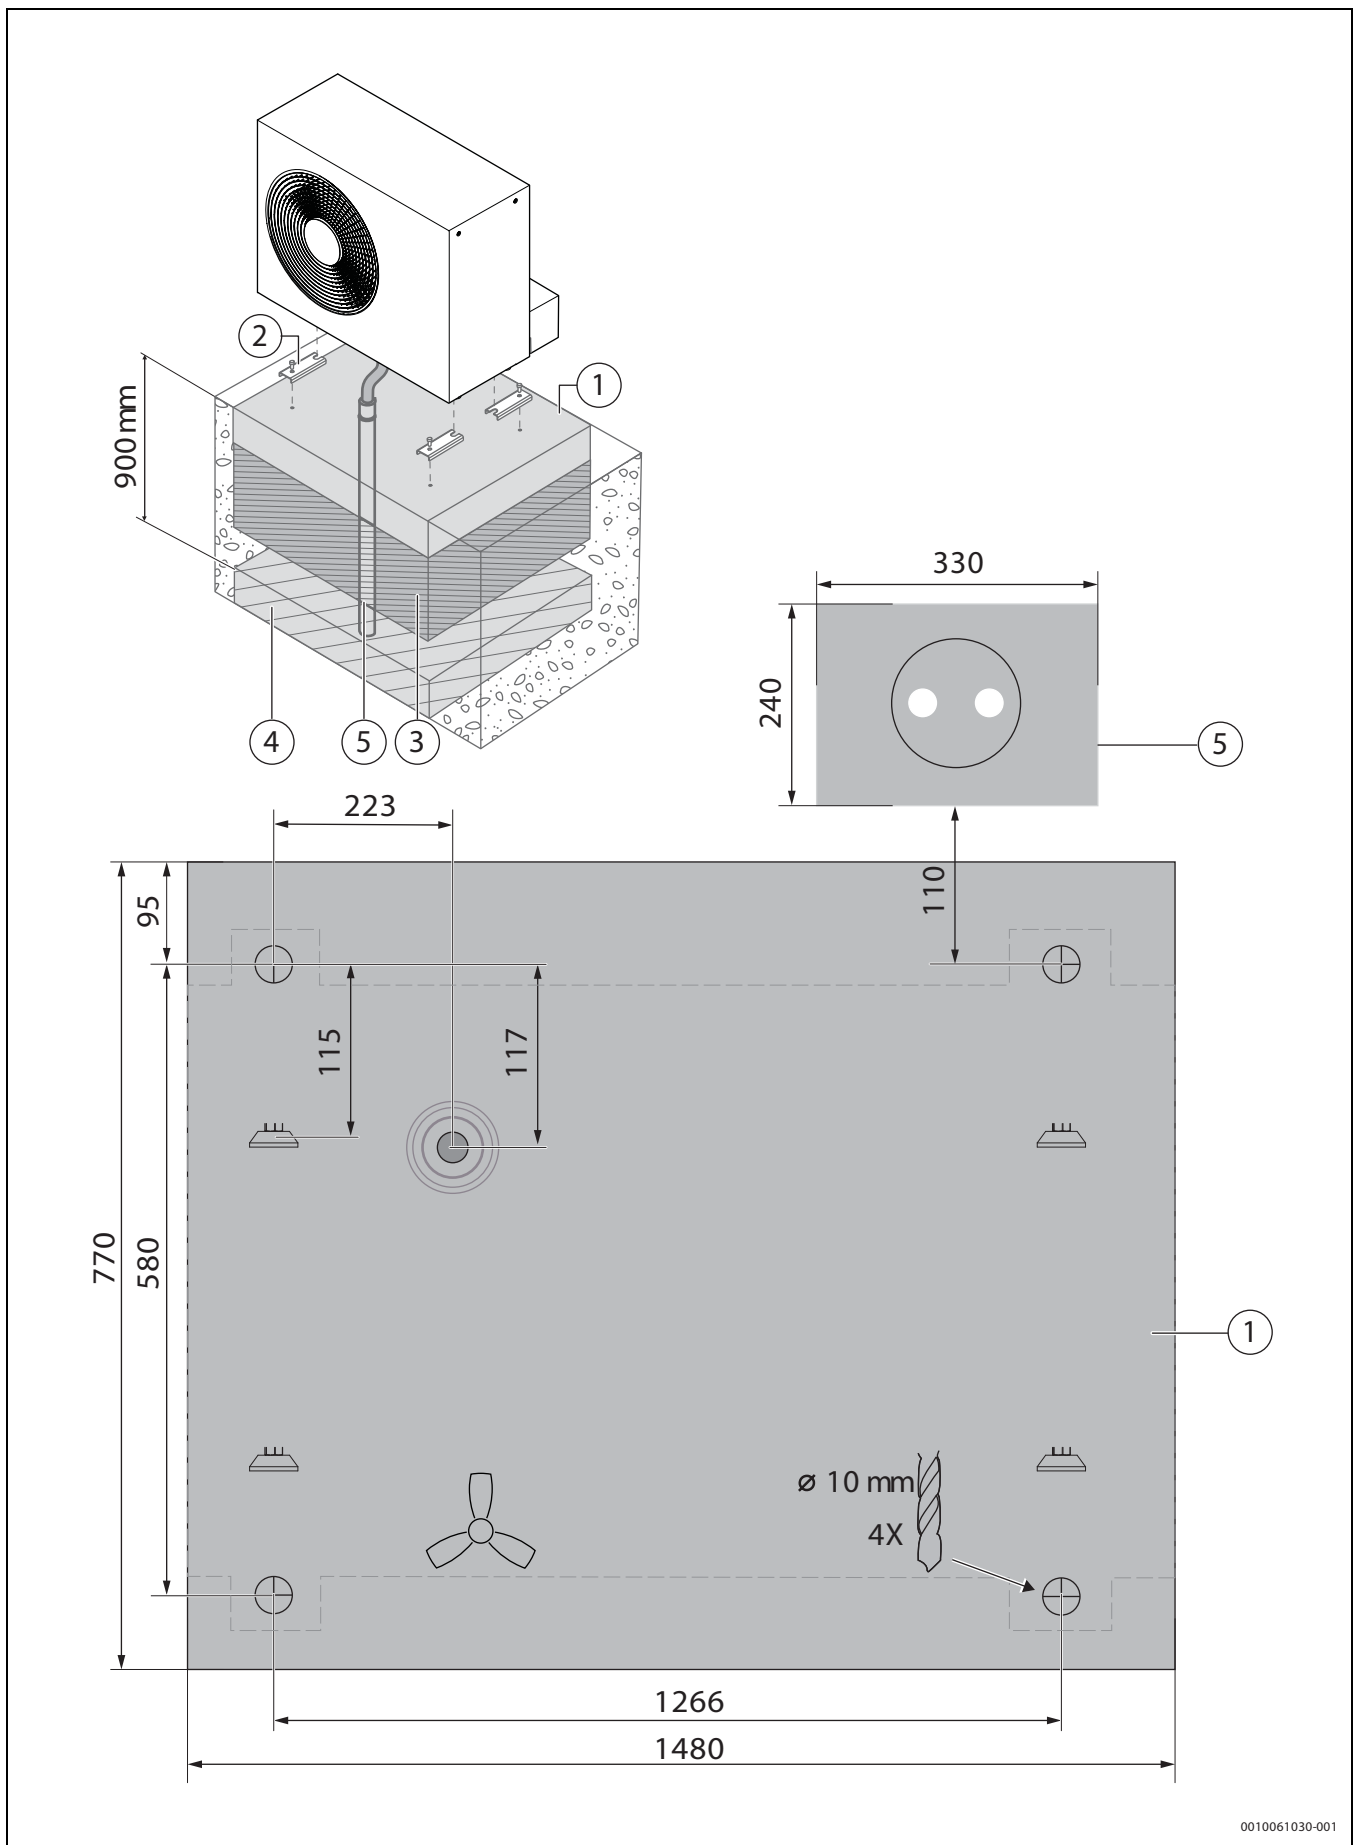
Installationspaket (INPA) mit Dämmschalen, bodenstehende Montage
